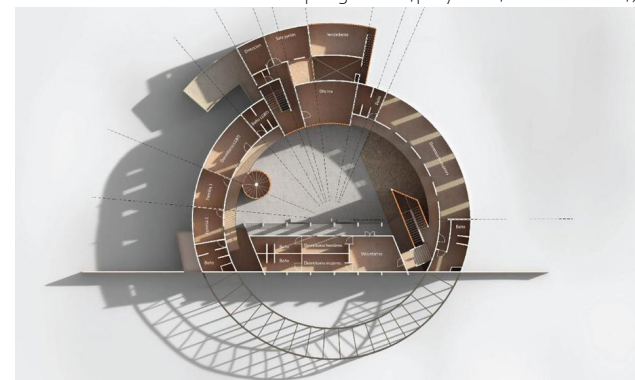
Planta Albergue. Nota. Planta Albergue [Plano], GS, 2019, Gaeta Springall Arquitectos (<https://www.gaeta-springall.com/proyectos/casa-monarca/>).
